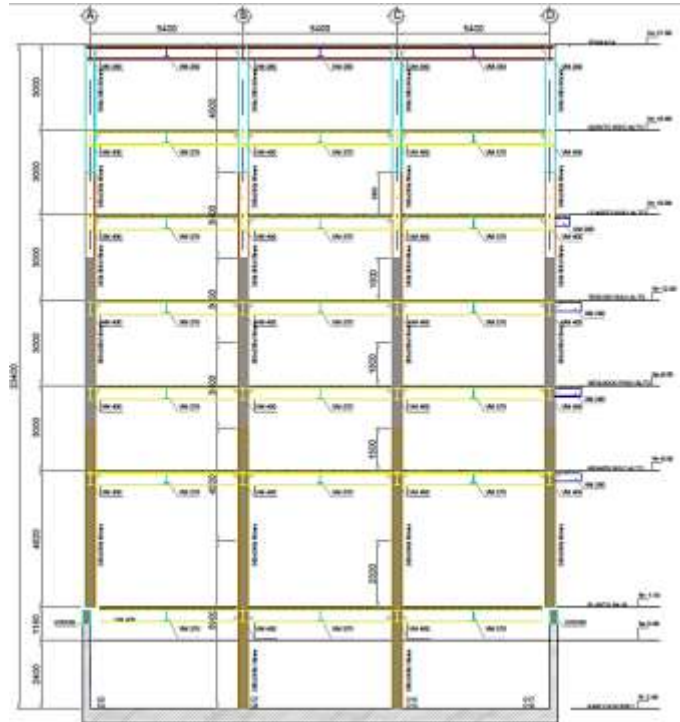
Vista en alzado del Pórtico referente al anteproyecto.
